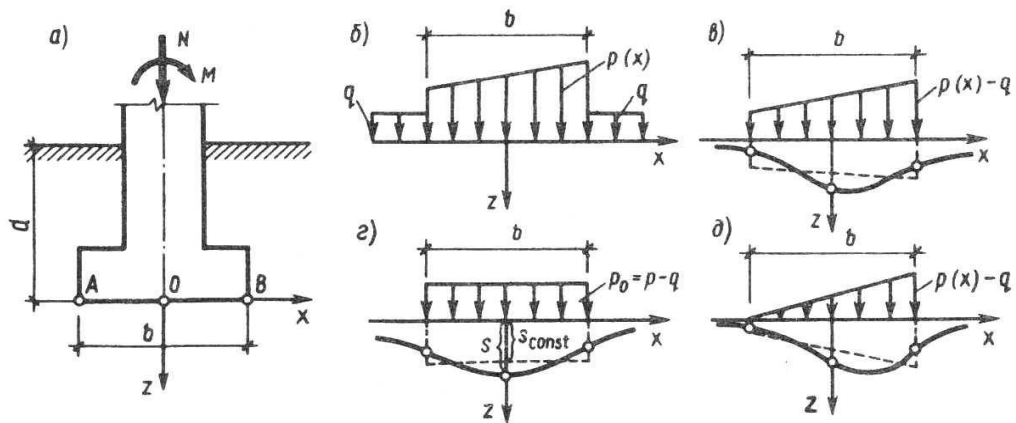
Схеми фундаменту: (а), розрахункова схема передачі навантаження на основу (б) різні види епюр додаткового тиску(в-д)
